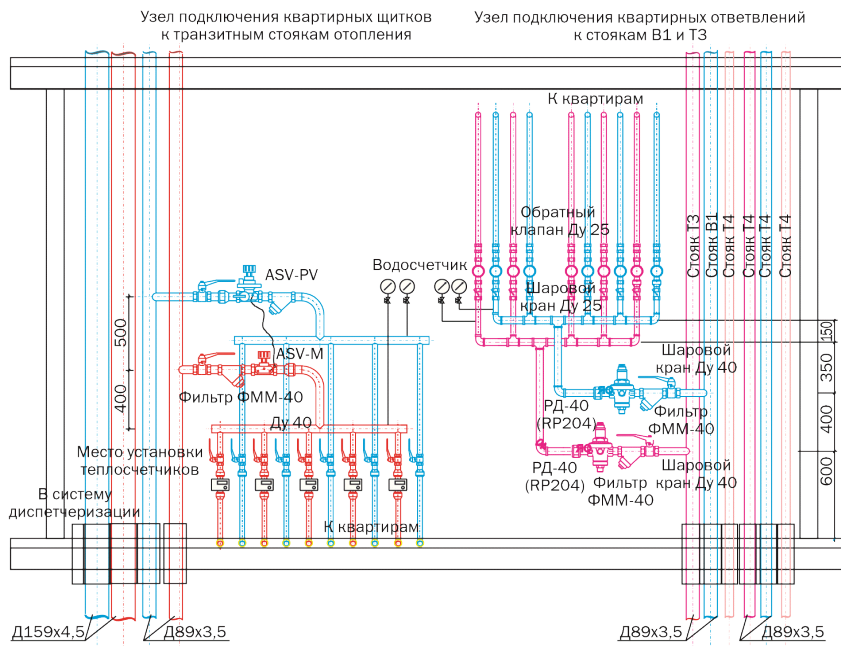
Схема этажного узла подключения поквартирных систем отопления и водоснабжения к вертикальным стоякам
